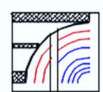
Detalle de propuesta para cimentación y mejoramiento del subsuelo para zapatas.
